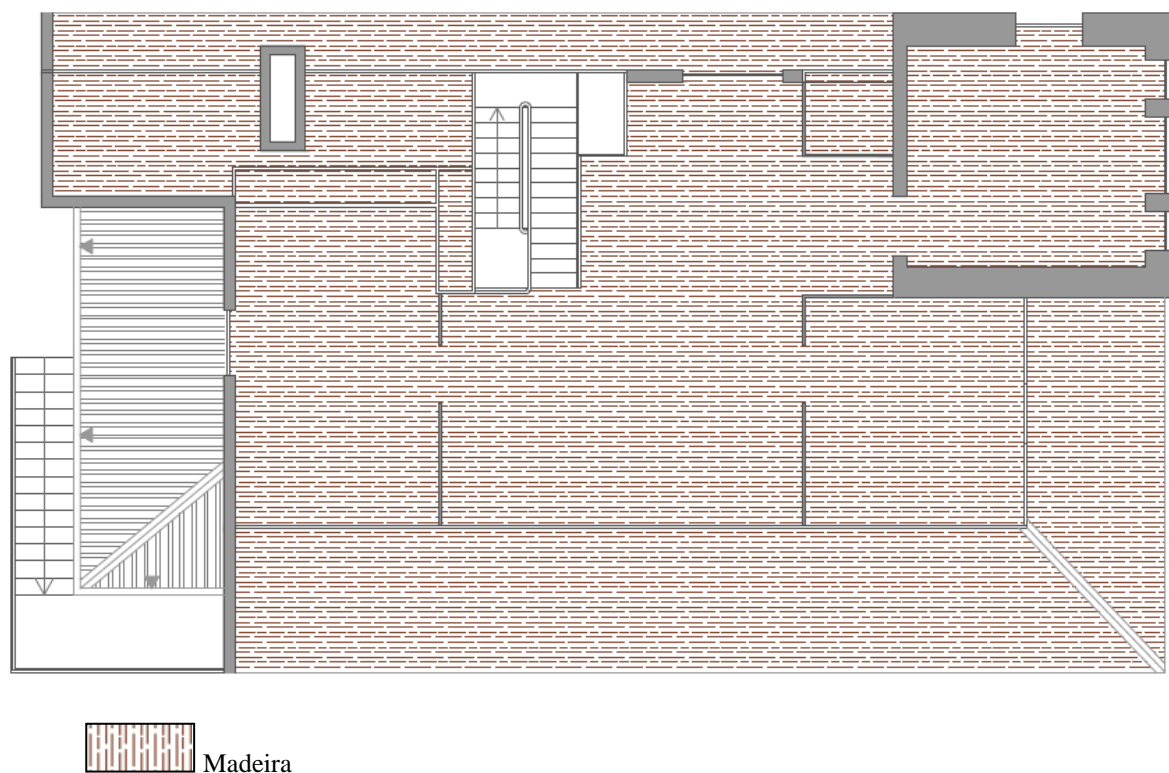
Representação da estrutura do pavimento. Piso 2
